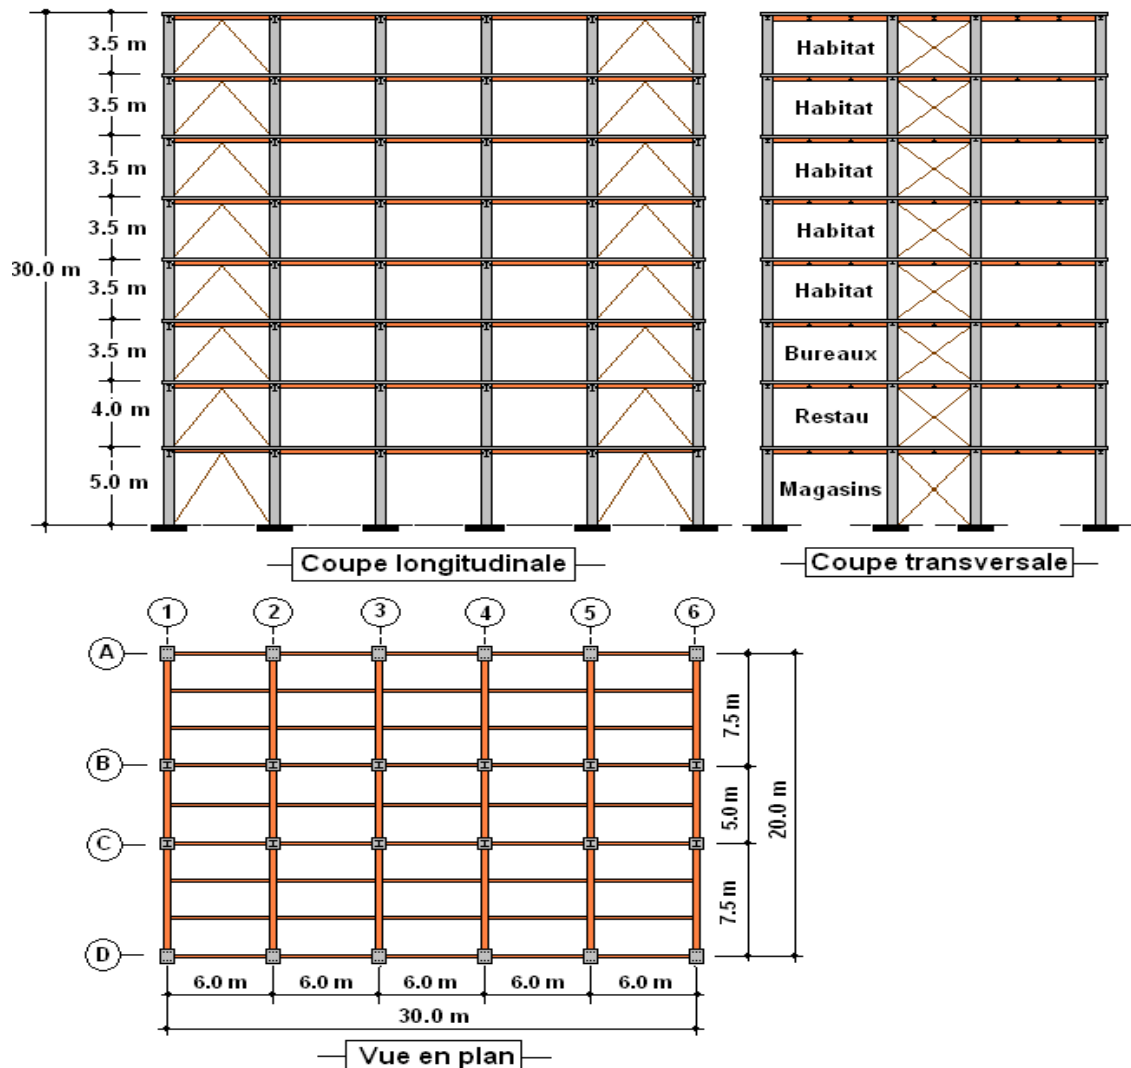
Ossature d'un bâtiment mixte à étages multiples
